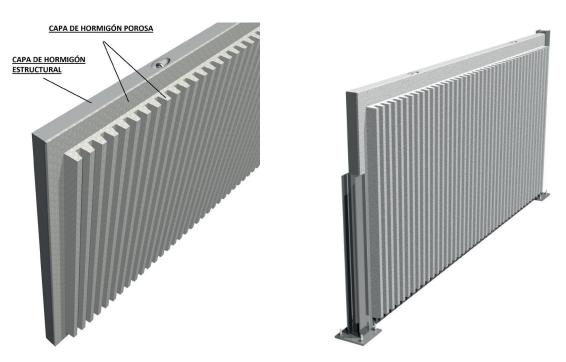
Detalles de pantalla de hormigón poroso absorbente.
